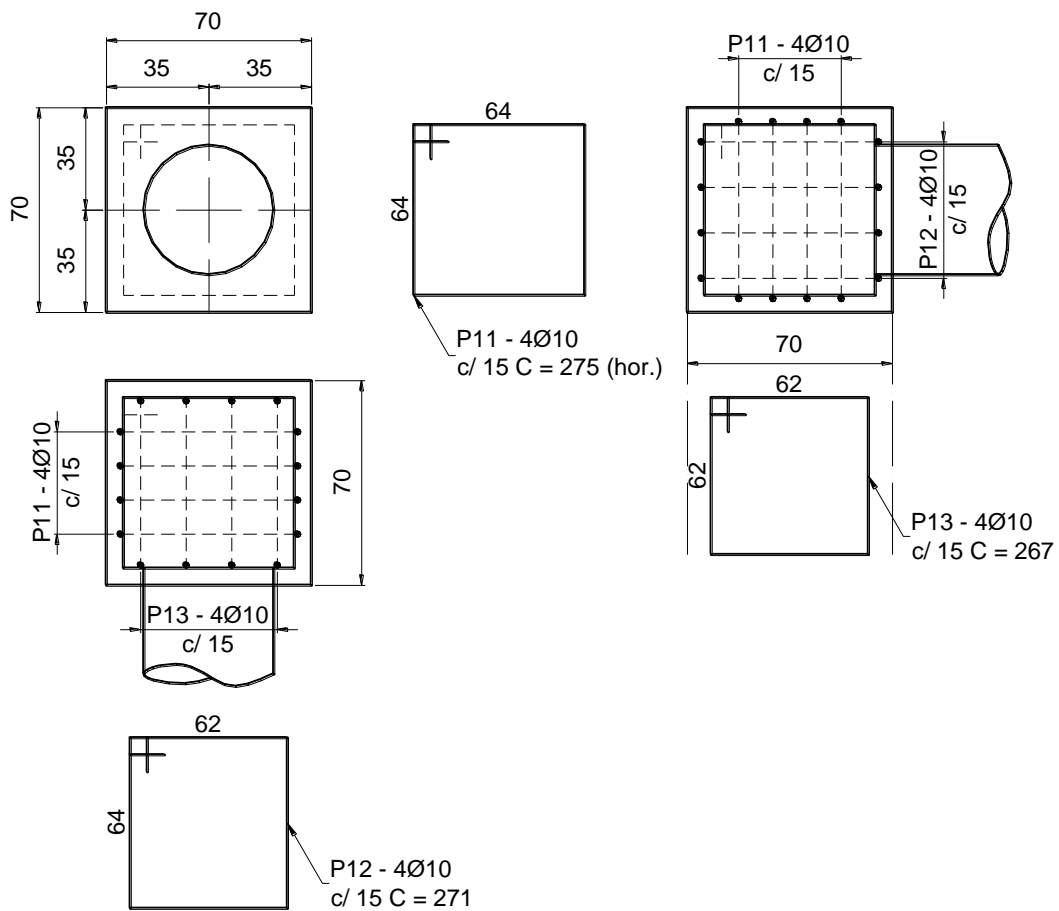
Exemplo de detalhamento das armaduras para o bloco de transição.
